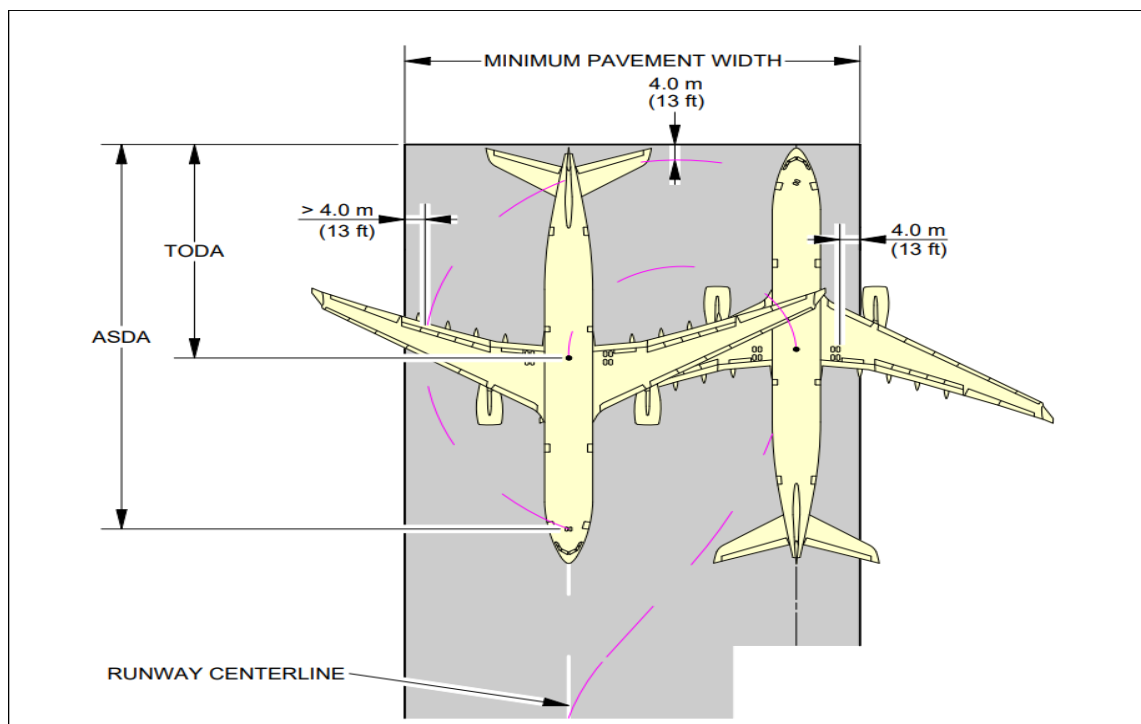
Les dimensions de TURN PAD pour A330-900 ([4])
